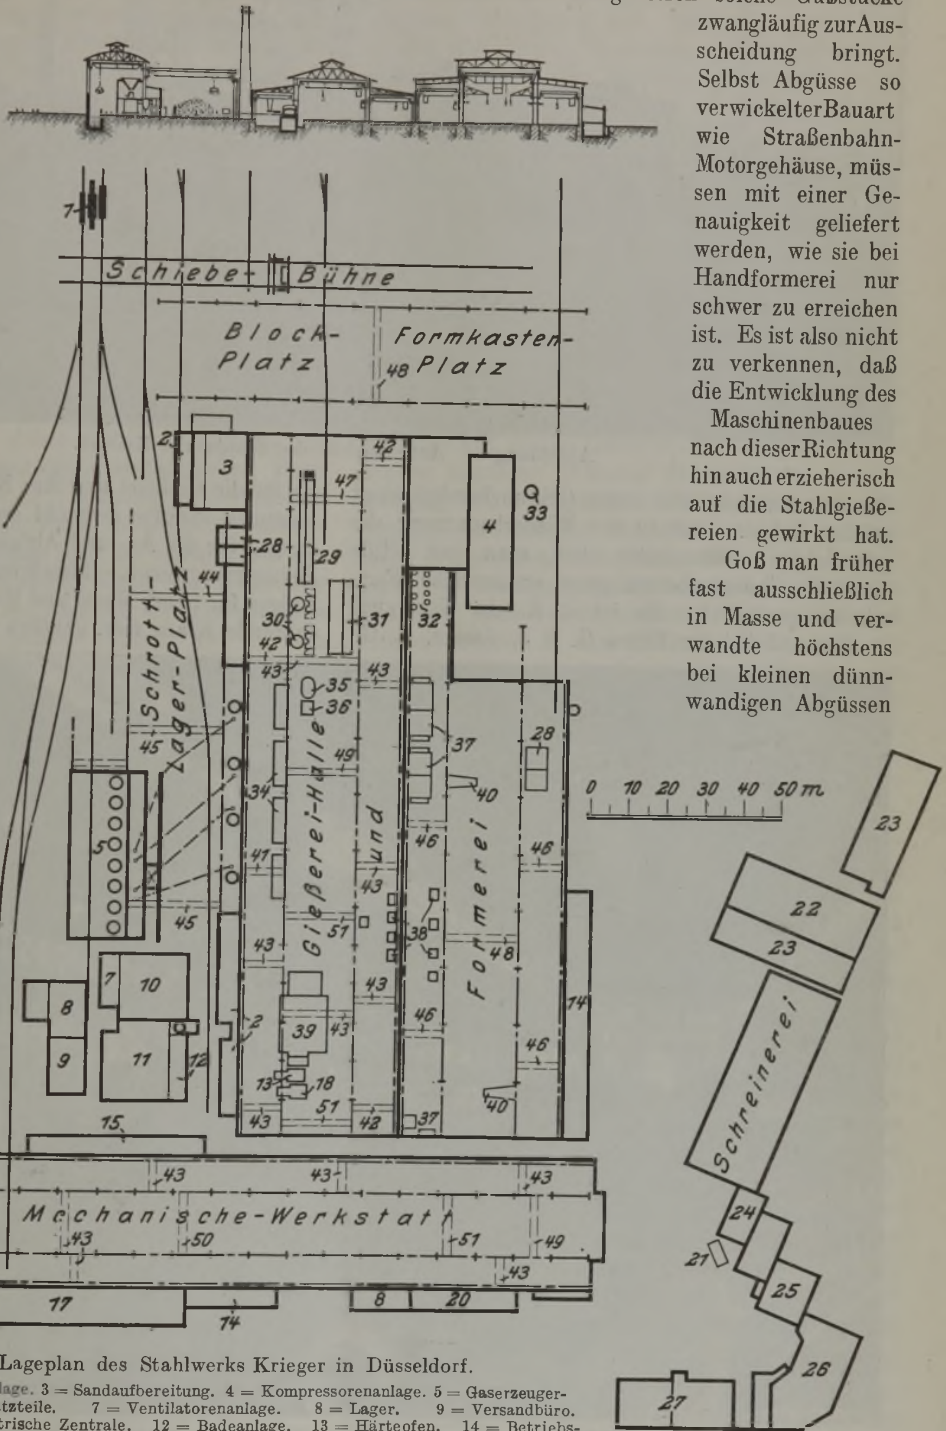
Lageplan des Stahlwerks Krieger in Düsseldorf.
